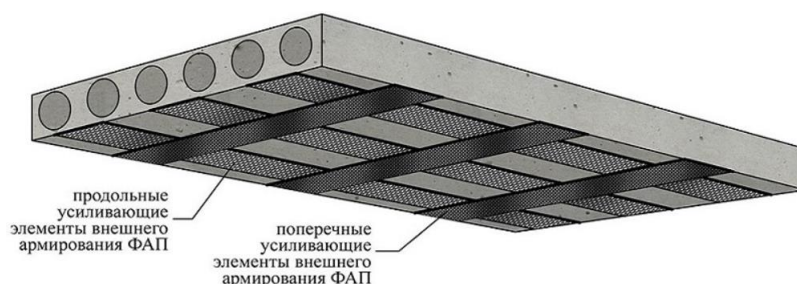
Усиление перекрытия путем наклейки углеволокна
